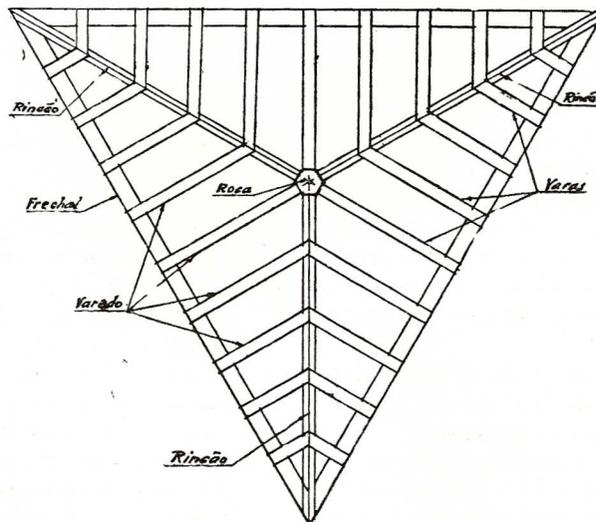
PLANTA DE COBERTURA TRIANGULAR
